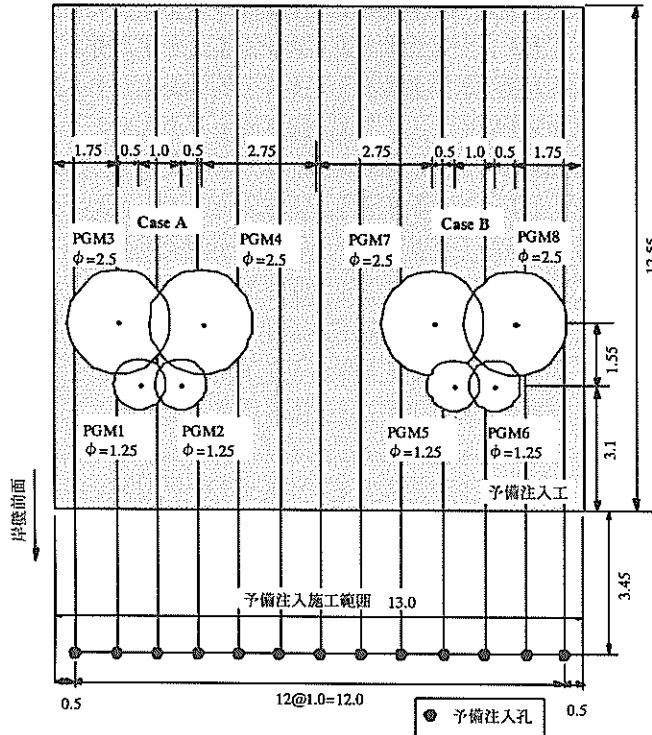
(a) 標準平面図 (志布志港岸壁実証実験)
